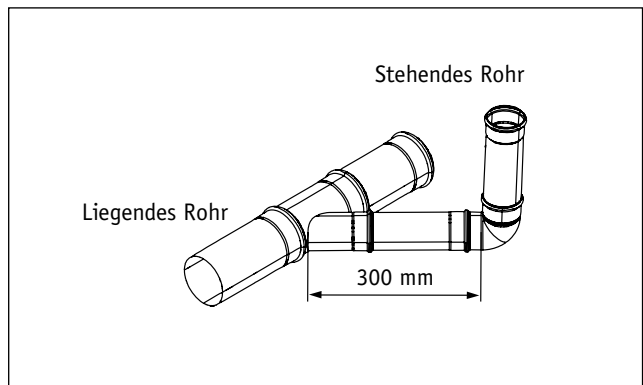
Bei größeren Fallhöhen und Belastungen sollte der Anschluss der stehenden Leitung mittels eines geraden Rohrstückes von mindestens 0,3 m erfolgen (Seitenanschluss).
